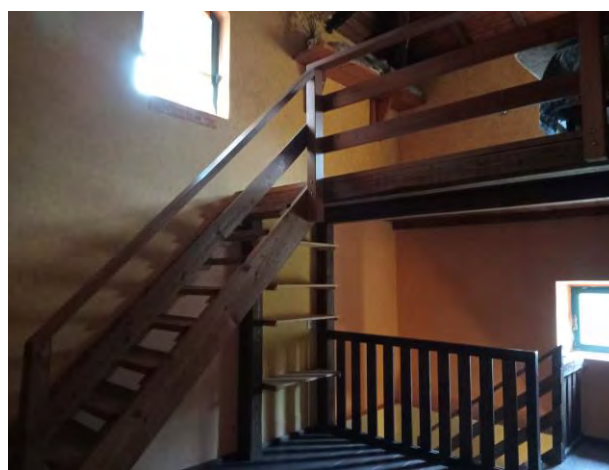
17 – La soffitta al piano secondo e le scale che salgono al soppalco
